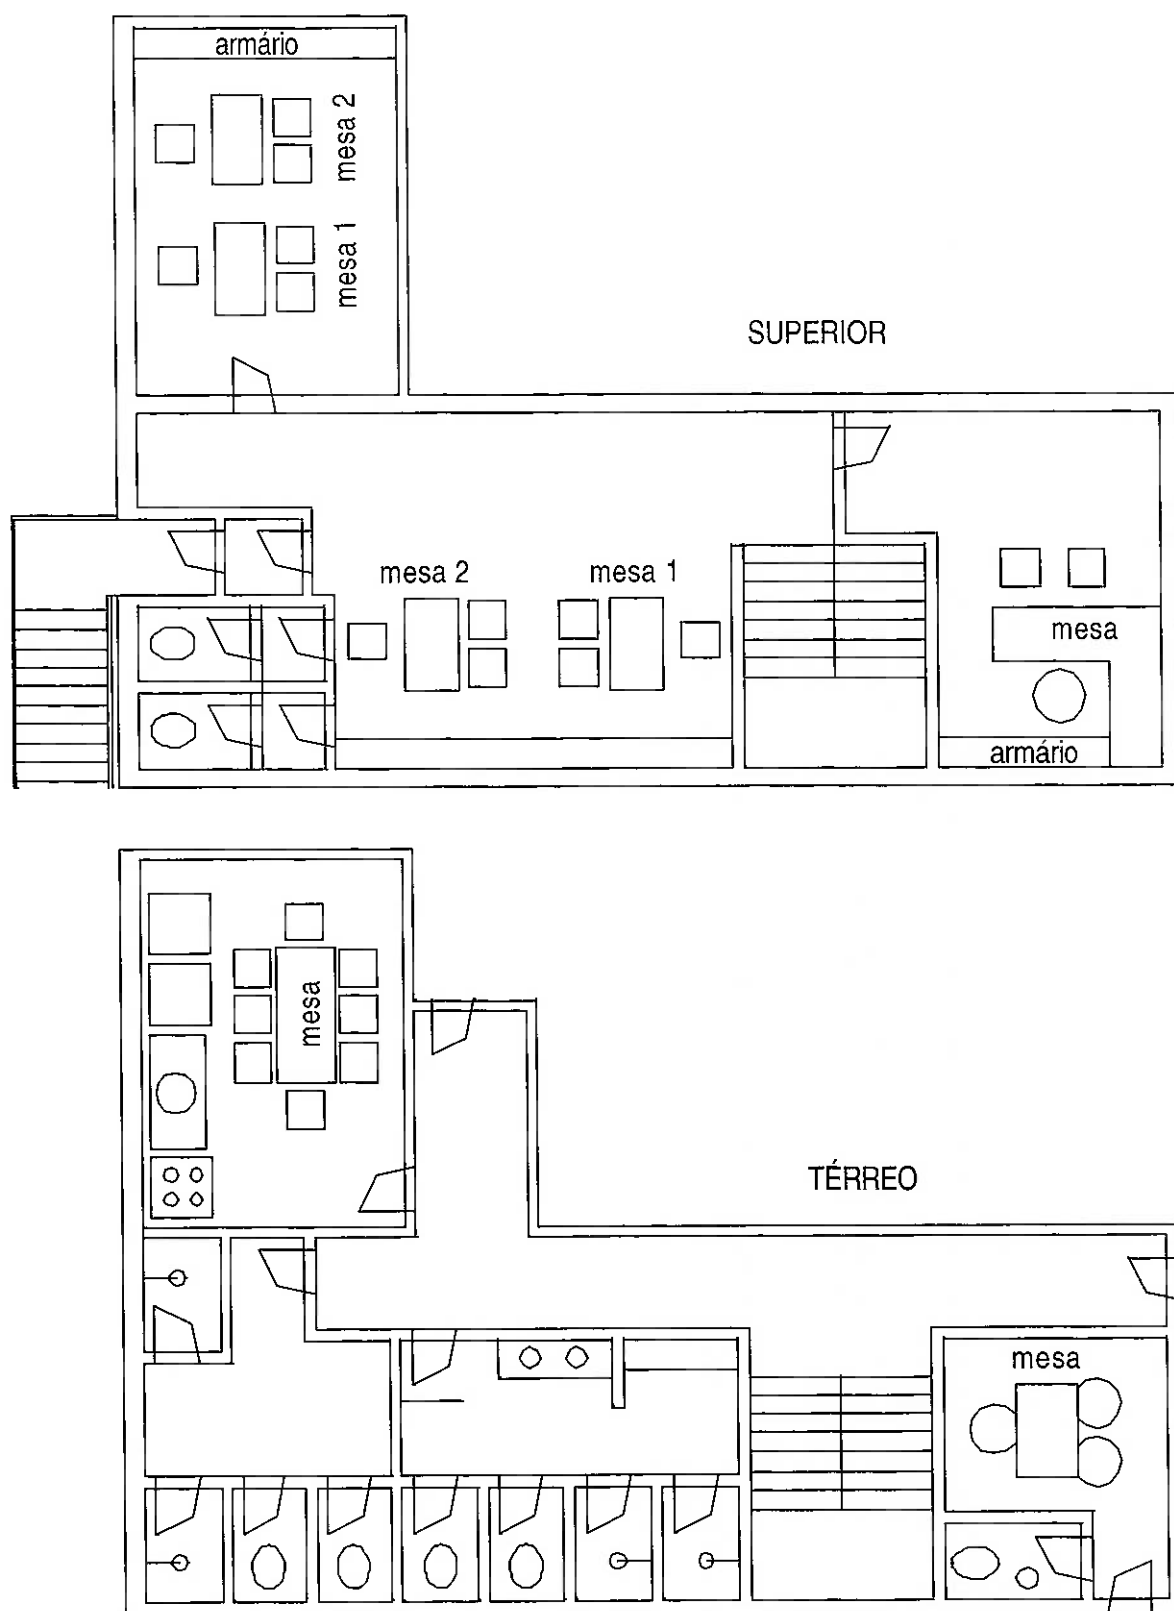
arranjo detalhado das áreas de apoio; escala 1:100
